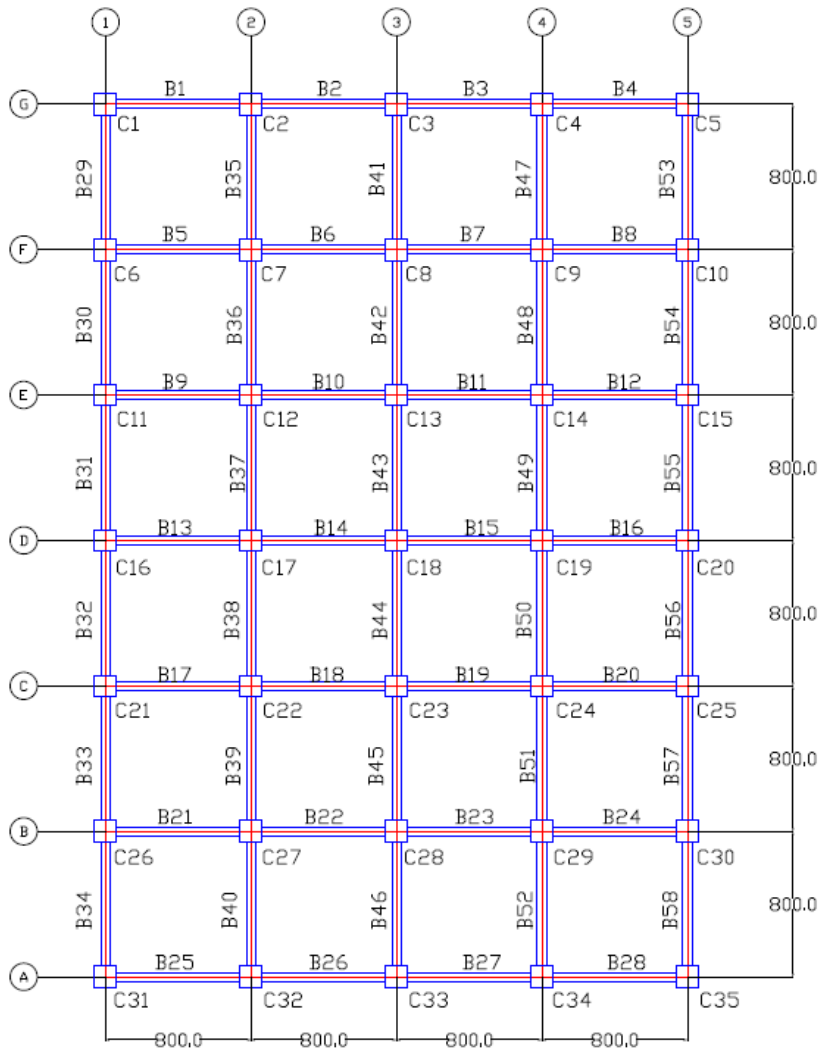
Planta con la enumeración de las vigas y columnas para todos los pisos del caso de estudio 2
